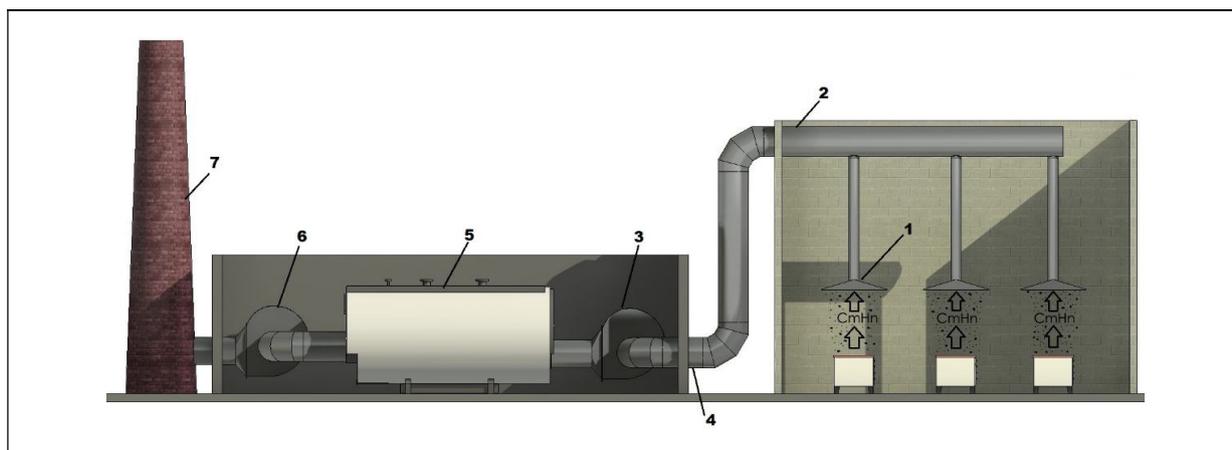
Схема транспорта промышленных вентиляционных выбросов, содержащих летучих органических соединений, в топку котлоагрегатов через вытяжной воздухопровод системы производственной вентиляции: 1 – вытяжные зонты; 2 – сборный воздухопровод вытяжной вентиляции; 3 – дутьевой вентилятор; 4 – всасывающий воздухопровод вентилятора; 5 – котлоагрегат; 6 – дымосос; 7 – дымовая труба
